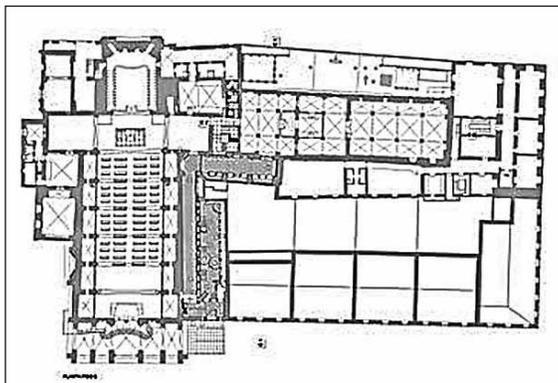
Évora. Planta da Igreja e remanescente do antigo convento.
